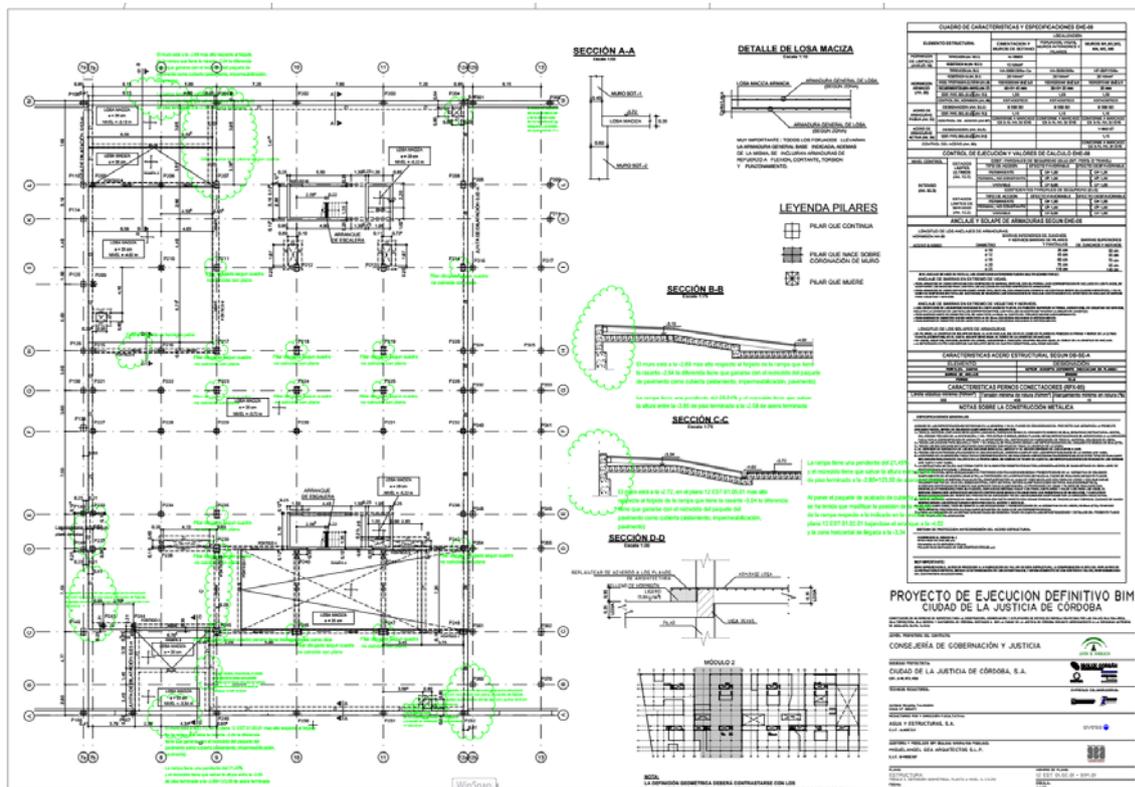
Plano de definición geométrica de la estructura (planta sótano -1, módulo M2)
